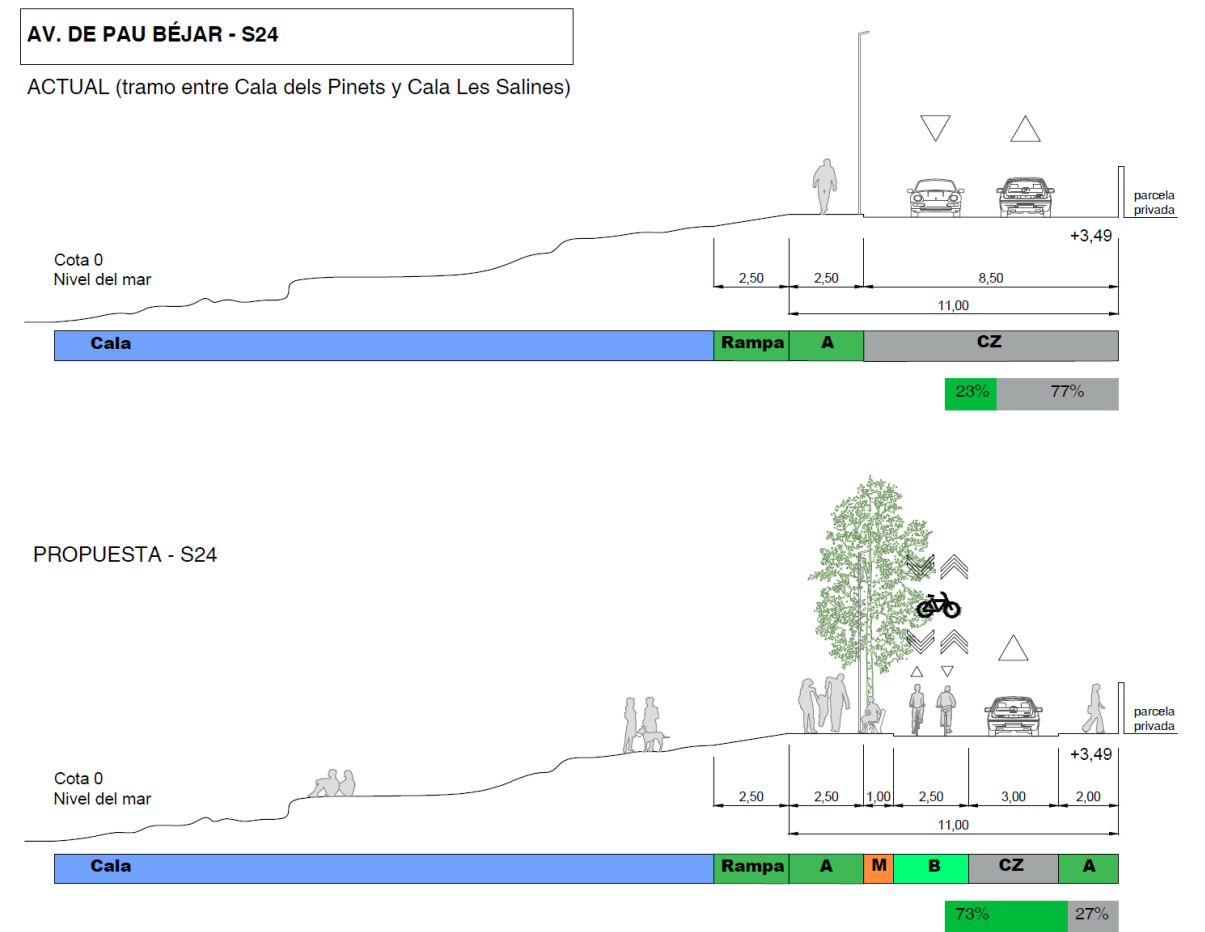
Sección Av. de Pau Béjar (S24) existente y propuesta. Fuente. Elaboración propia
